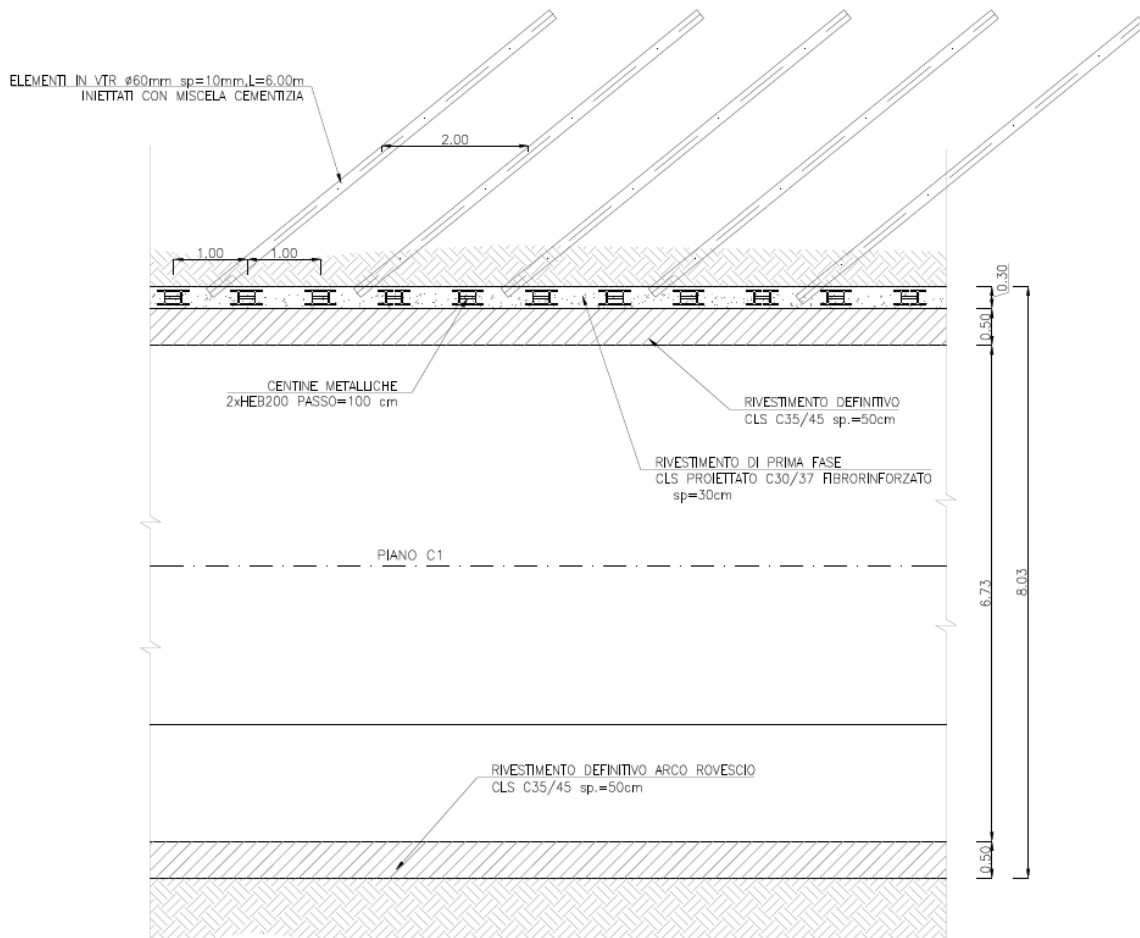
Sezione tipo GV-4: geometria del cavo e interventi di sostegno, sezione longitudinale
